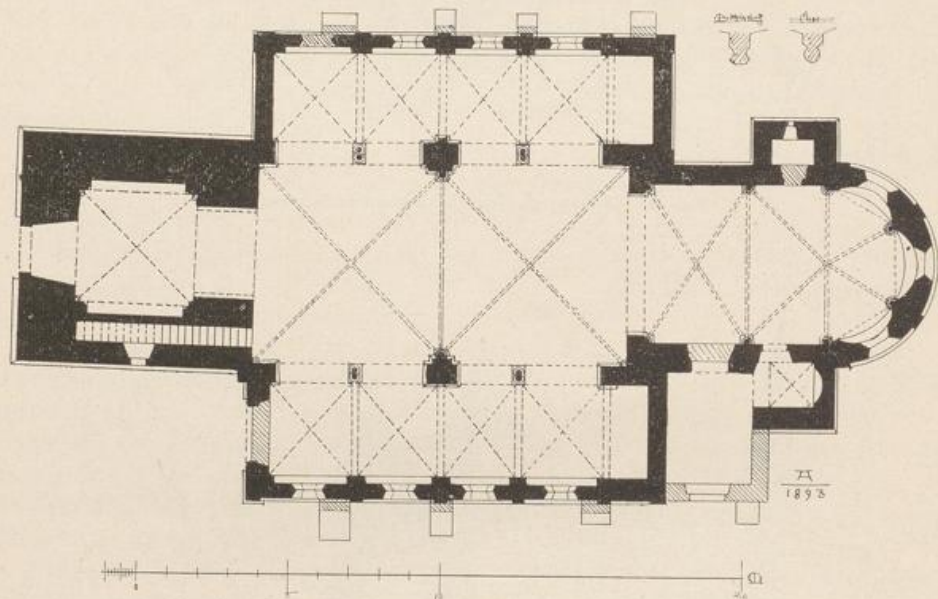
Rheinkassel, Grundriss der Pfarrkirche.
